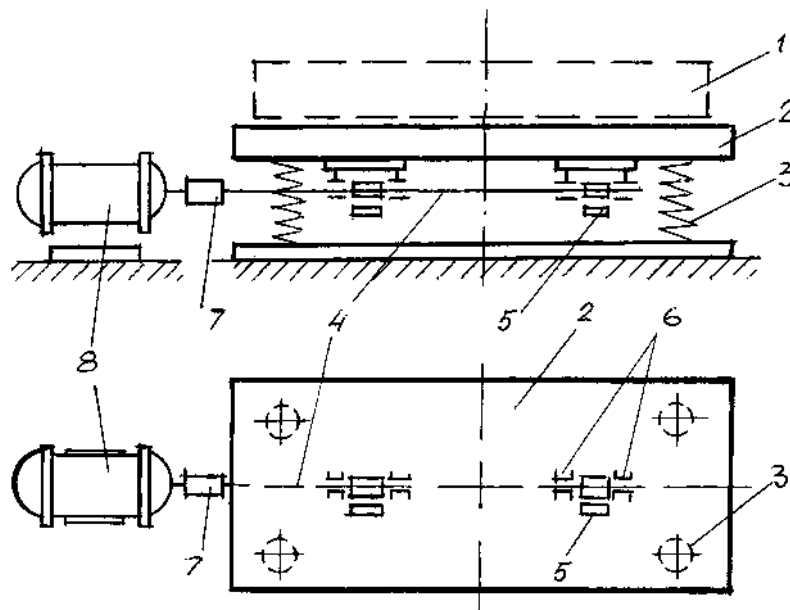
Одношальний вібромайданчик: 1 – форма; 2 – вібраційна рама; 3 – пружина; 4 – вал; 5 – дебаланс; 6 – підшипники; 7 – муфта зчеплення; 8 – електродвигун
